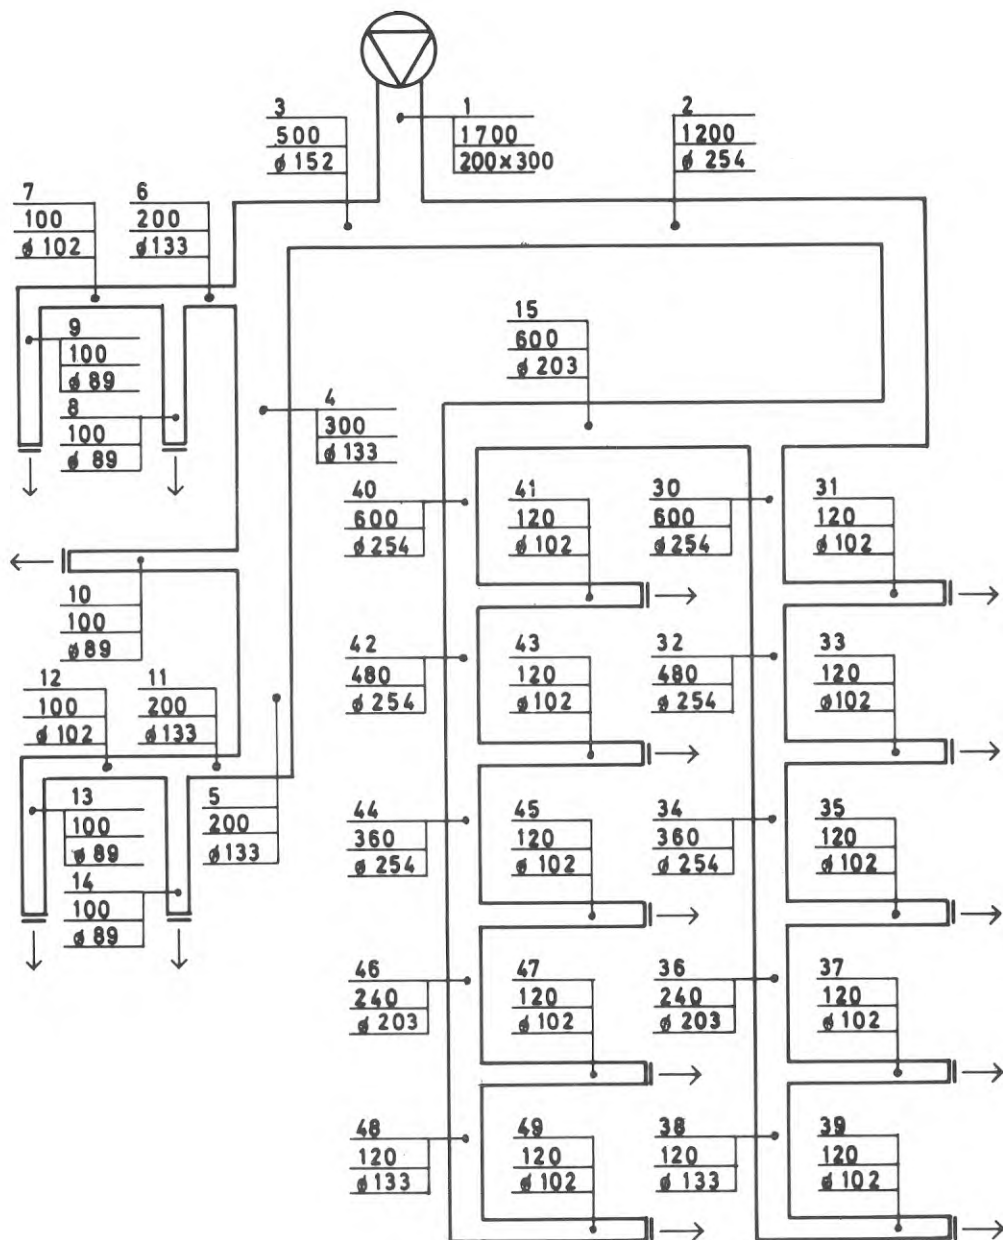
3 Exempel med av programmet valda dimensioner införda
